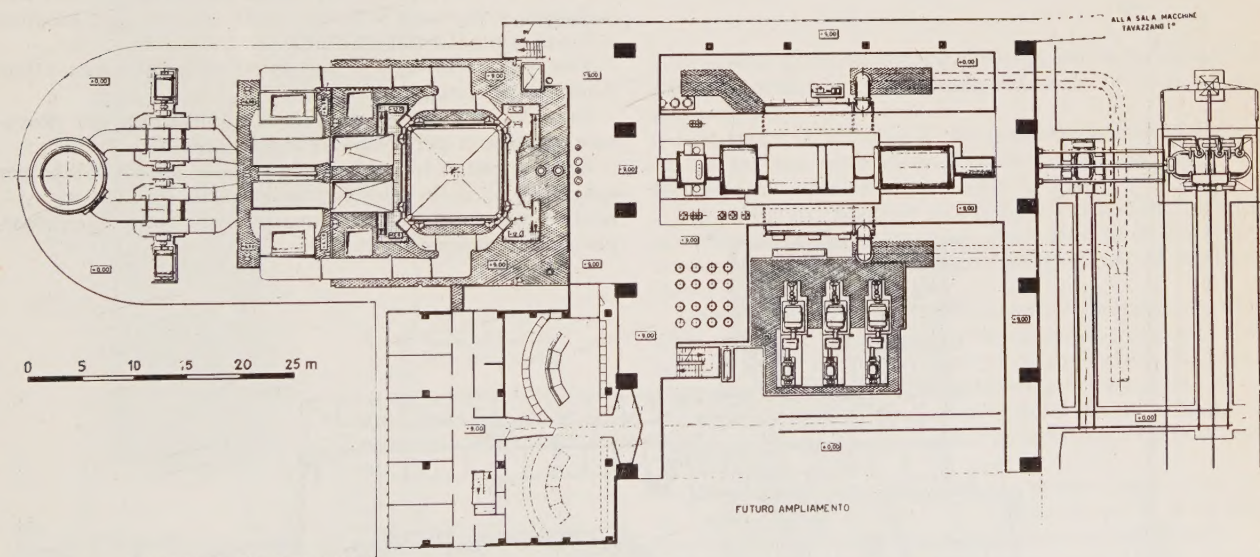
Pianta del complesso caldaia - sala macchine - fabbricato quadri.
